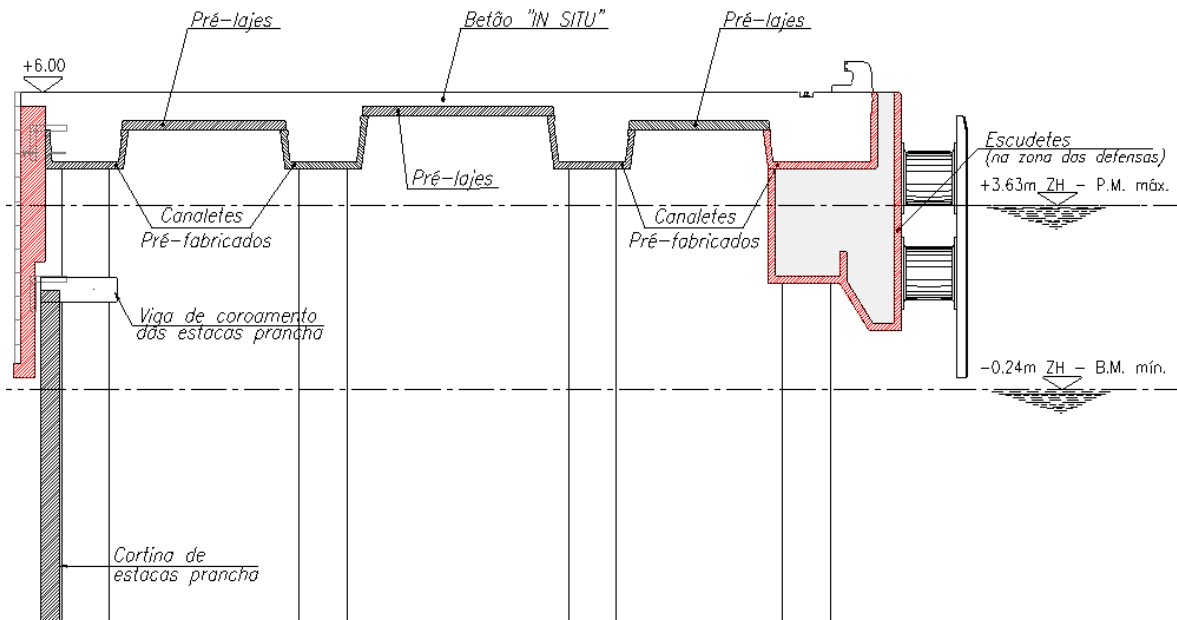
Alterações das configurações dos elementos pré-fabricados
